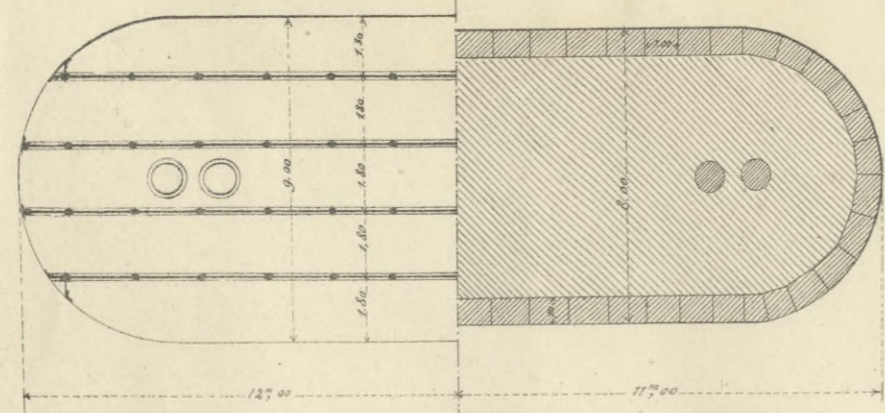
Vue de Face c.d. à 0^e005 pour 1^e00.
